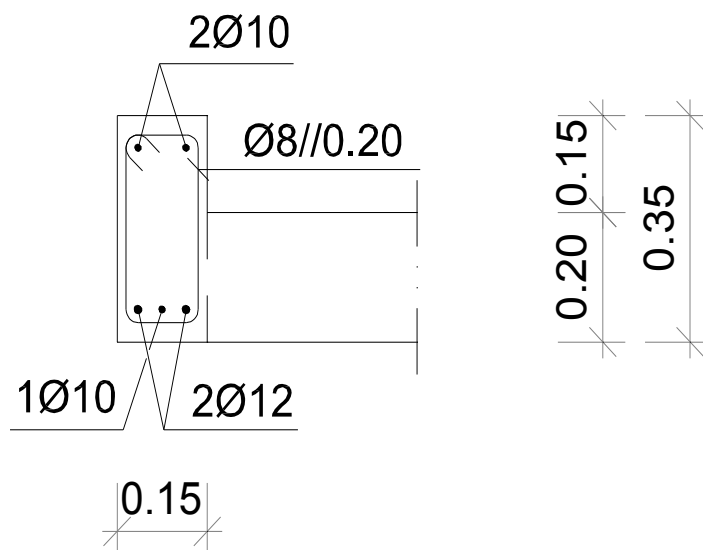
PORMENOR DAS ARMADURAS NA VIGA (AUTOCAD)
